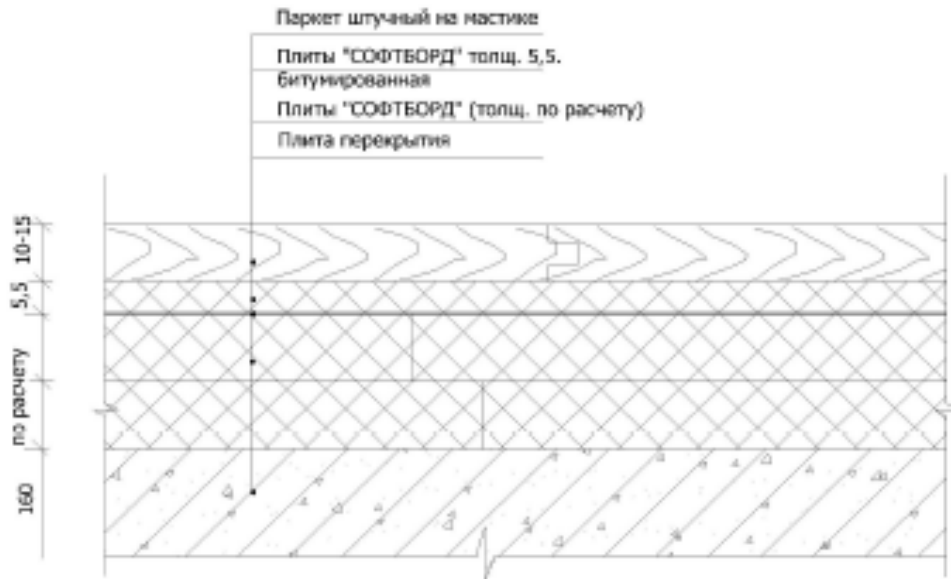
Применение плит СОФТБОРД в полах междуэтажного перекрытия без стяжки
